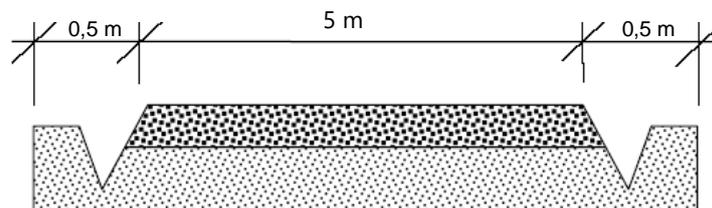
Vue en coupe d'une piste d'accès - Source : Vestas
